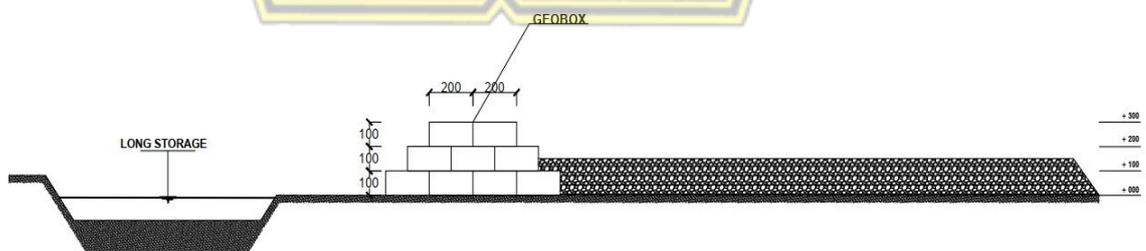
Denah Alternatif 3 (Area Dekat Pemukiman)
